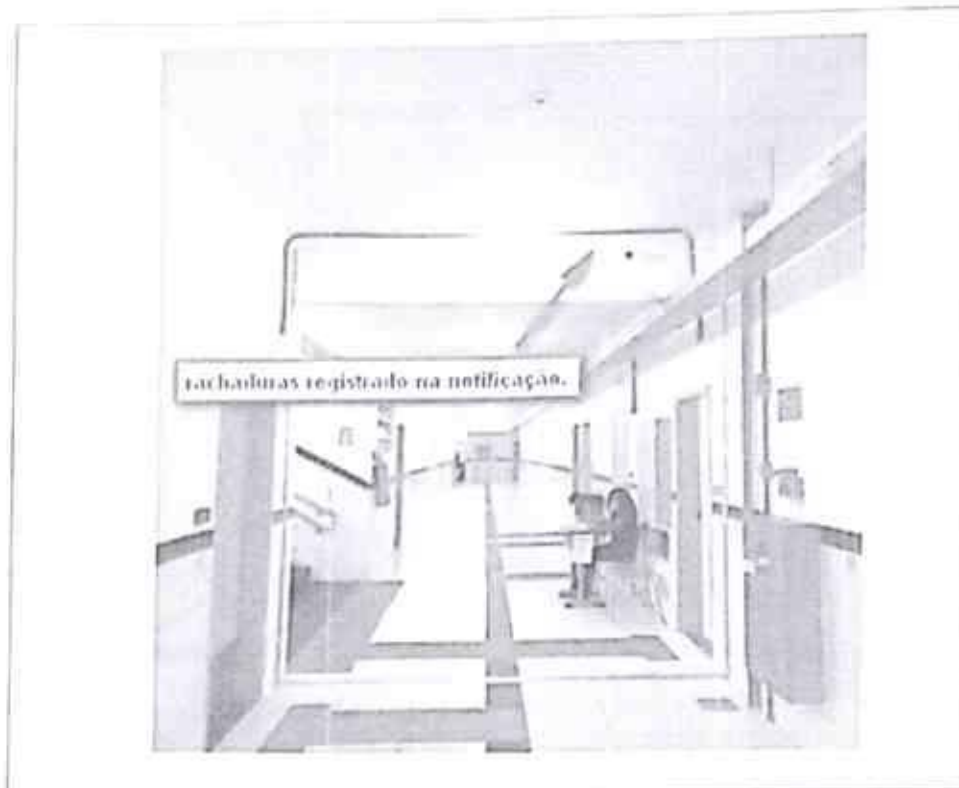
Imagem da junta de dilatação do pavimento létrico
